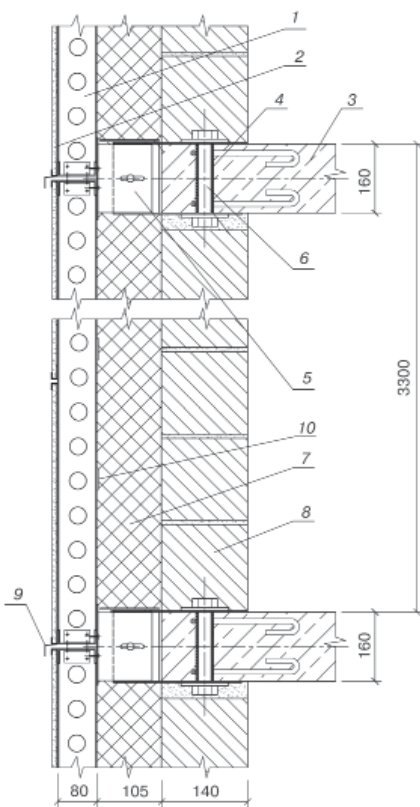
Конструкция наружной стены с НФС ВВЗ с фасадной панелью: 1 – фасадная панель на основе металлического каркаса; 2 – керамогранитная плитка; 3 – плита перекрытия; 4 – стальная трубка с анкерами; 5 – консоль регулируемая; 6 – болт с гайкой; 7 – слой утеплителя; 8 – кладка из ячеисто-бетонных блоков или кирпича; 9 – козырек; 10 – планка фиксации утеплителя
